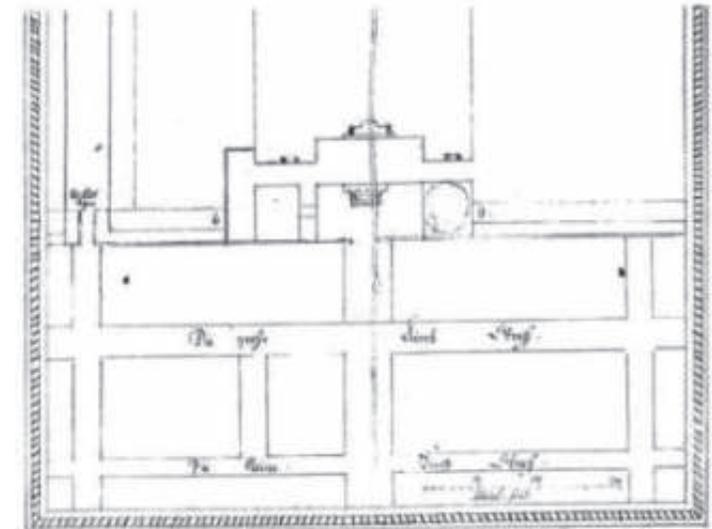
\_16 Planskizze zum Bau des 'Schlosses' 1790
